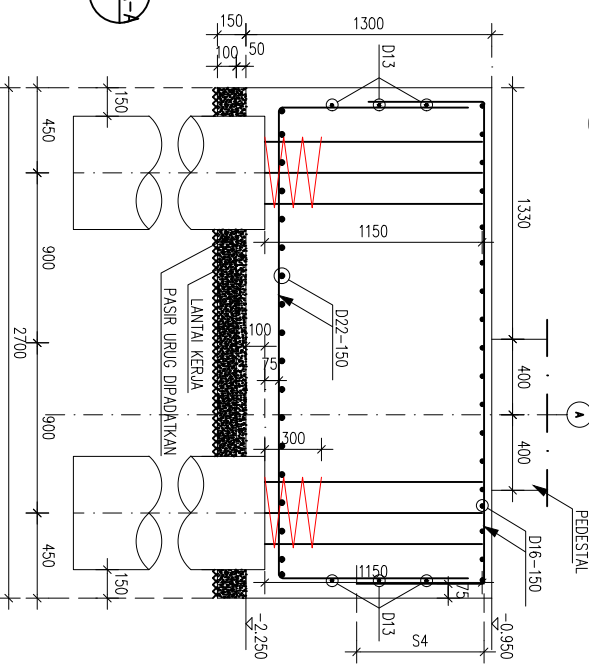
DETAIL PONDASI TIPE PS-4 (T=1300MM)
